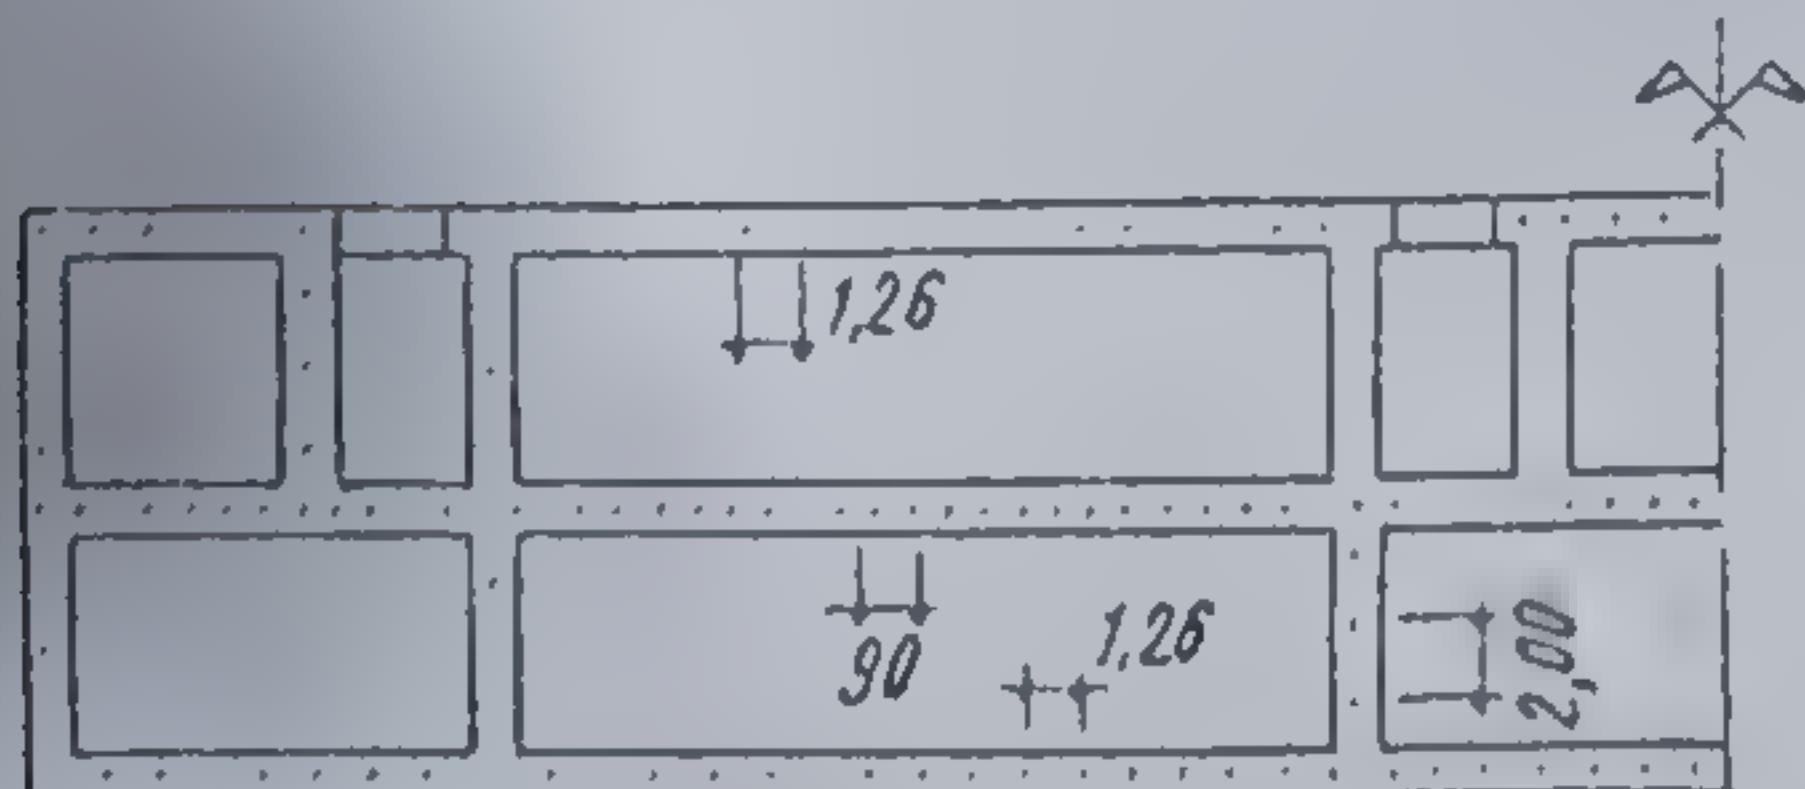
Schema de distribuție a piloților sub fundație.
